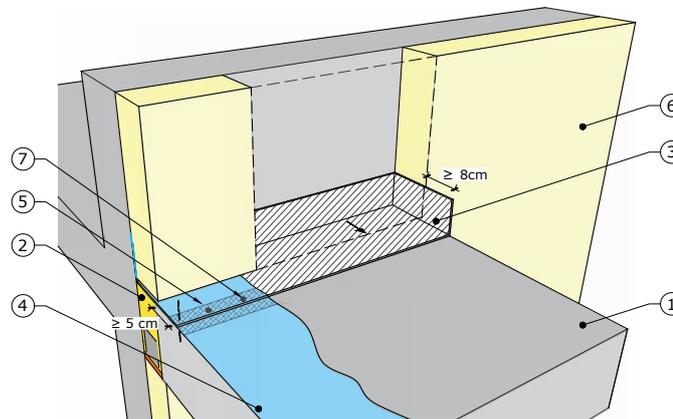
Exemple de traitement de relevé au droit d'un rupteur - Vue en perspective
